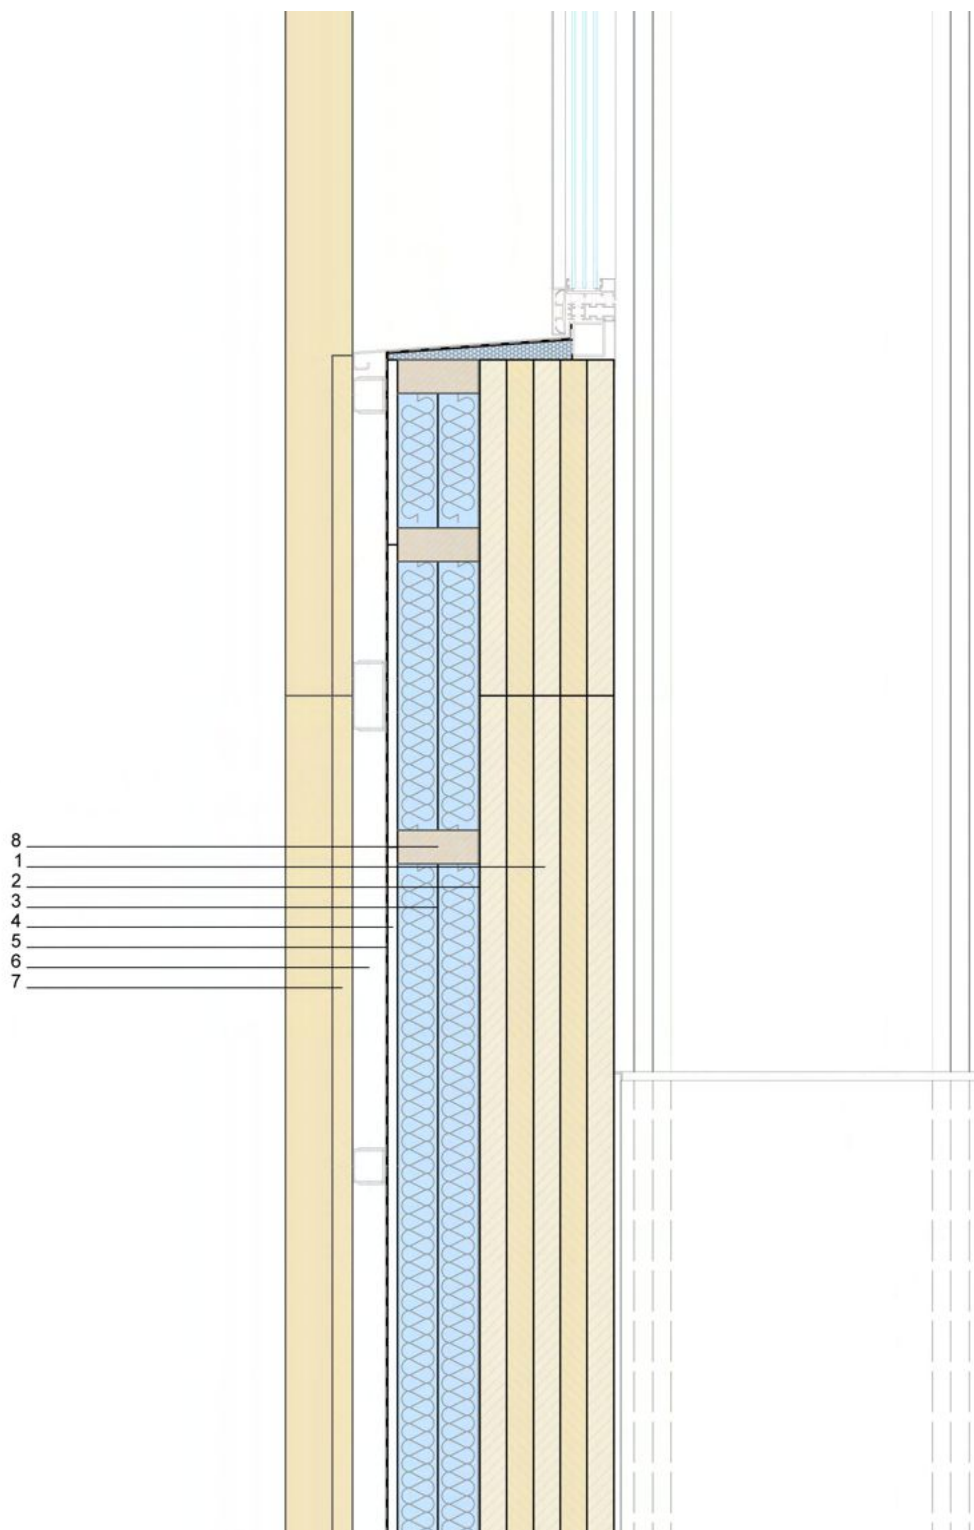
Dettaglio parete perimetrale e infisso.
